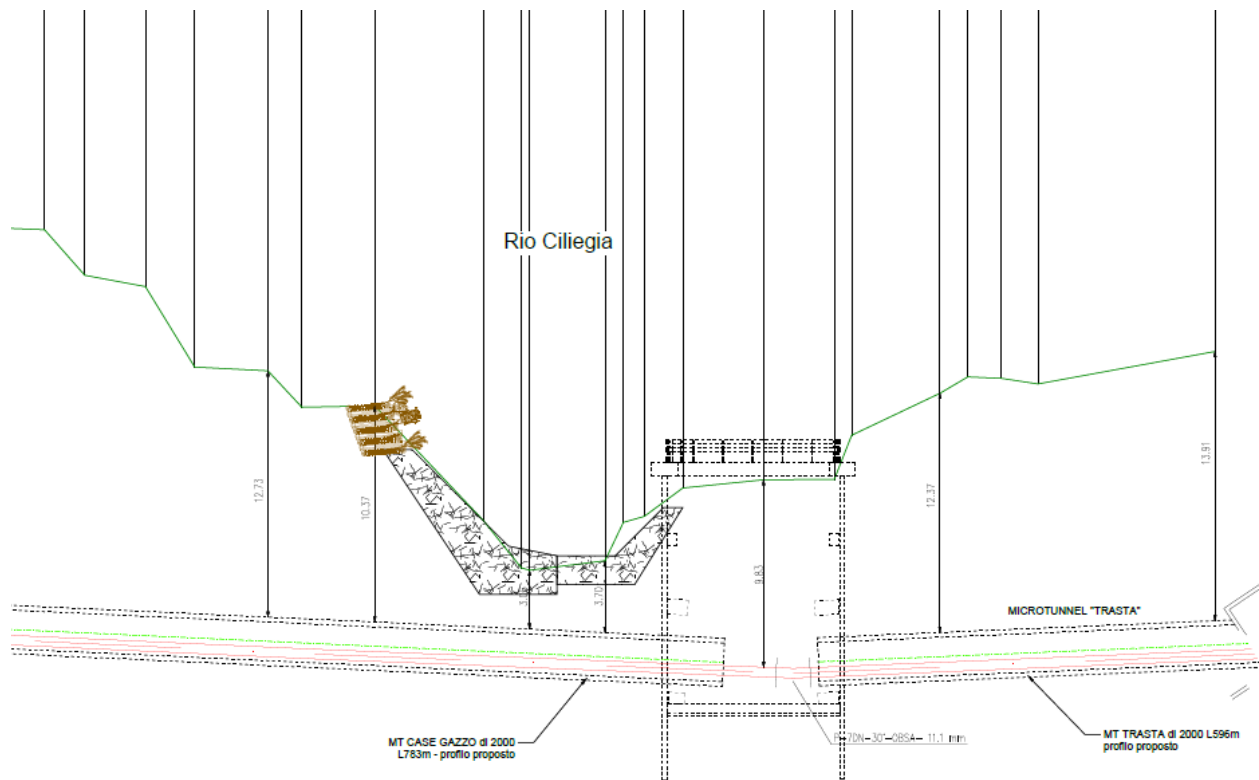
Sezione del Rio Ciliegia secondo il progetto alternativo prescelto
